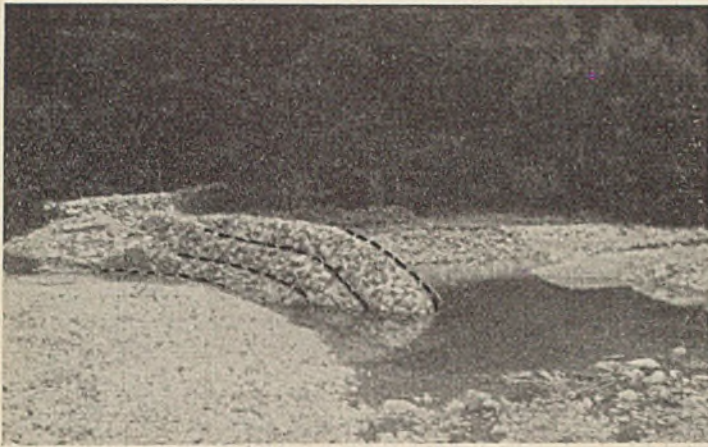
Bühnenbau aus mehreren Drahtnetzwalzen im Zinkenbach (Oberösterreich).
